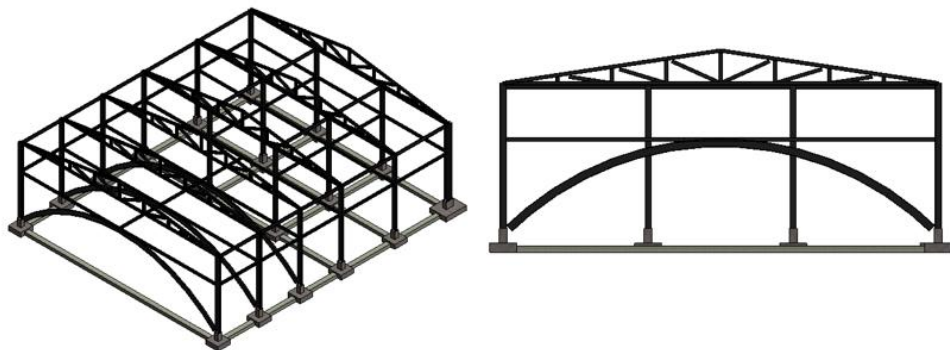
Estructura de la zona de oficinas tras disponer la celosía para la cubierta.
